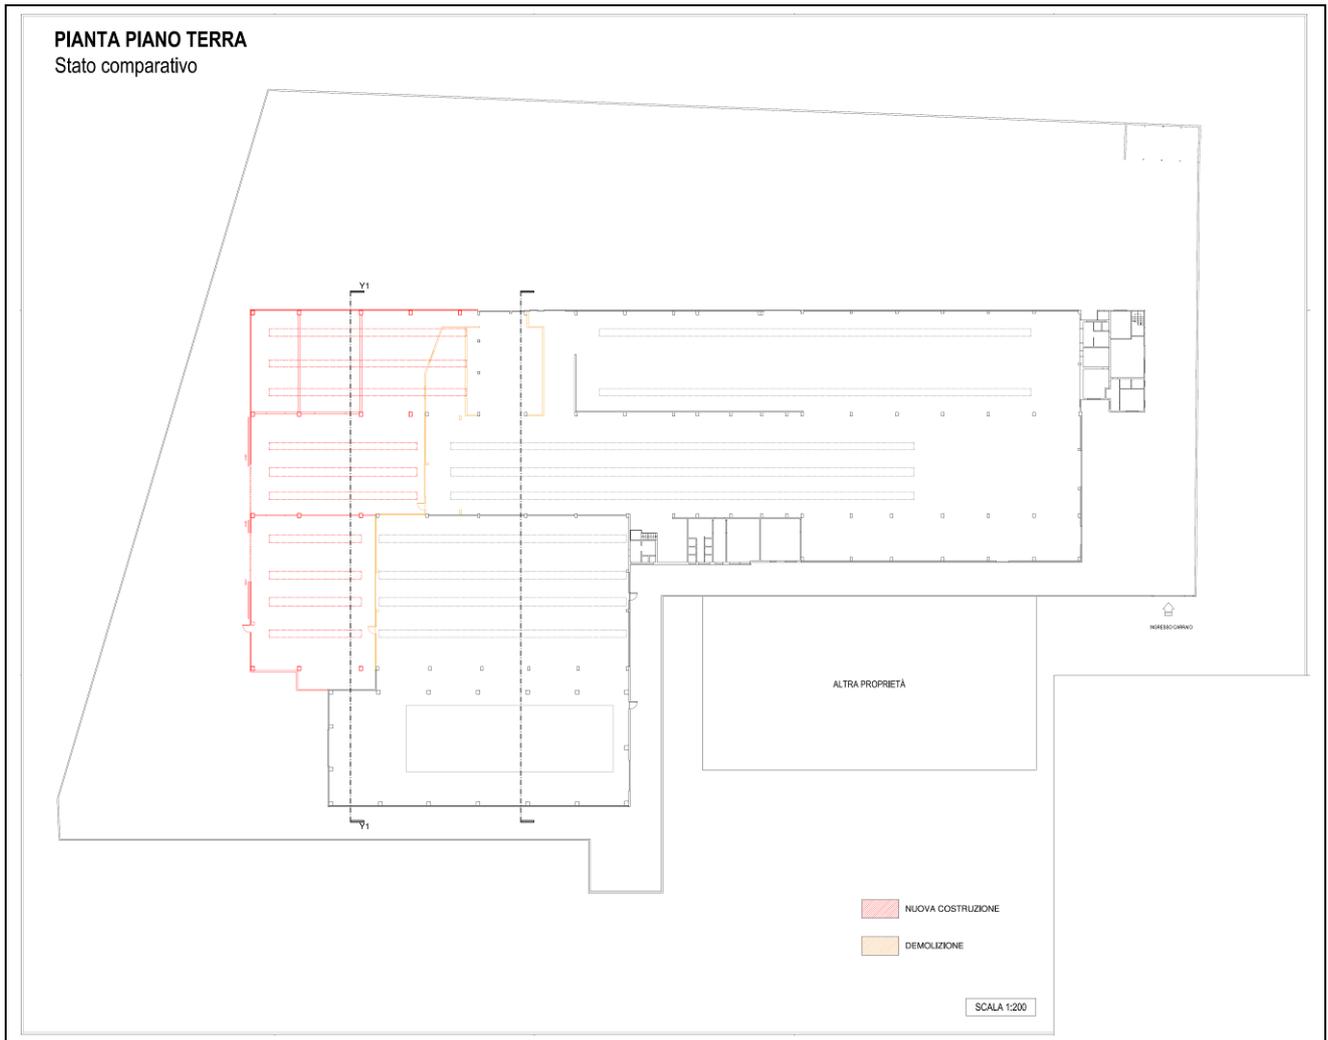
Pianta piano terra, stato comparativo (fuori scala).
